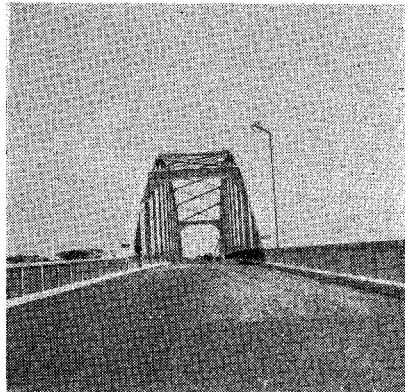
(b) 新橋正面 (右岸側より) (Front View of the New Bridge from the Right Bank)
